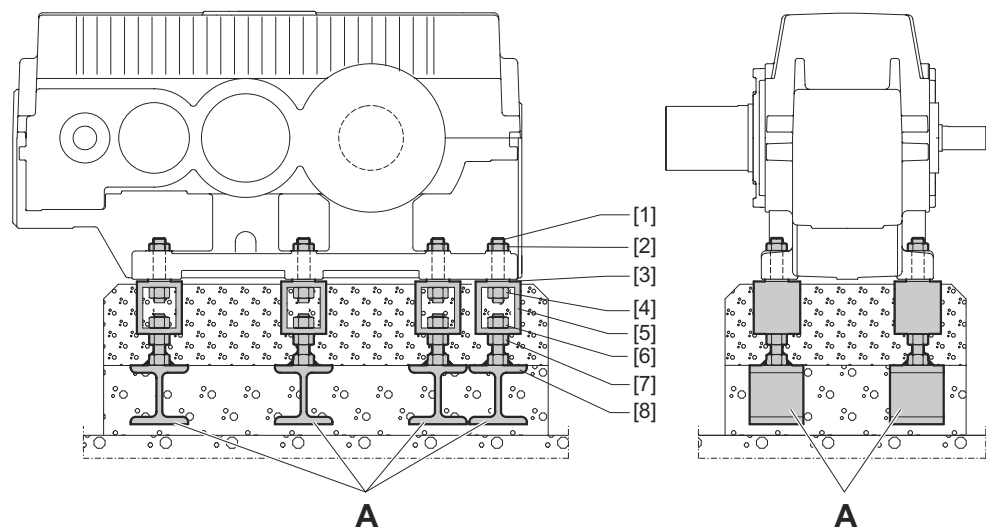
Stahlbetonfundament für Industriegetriebe M...F..
